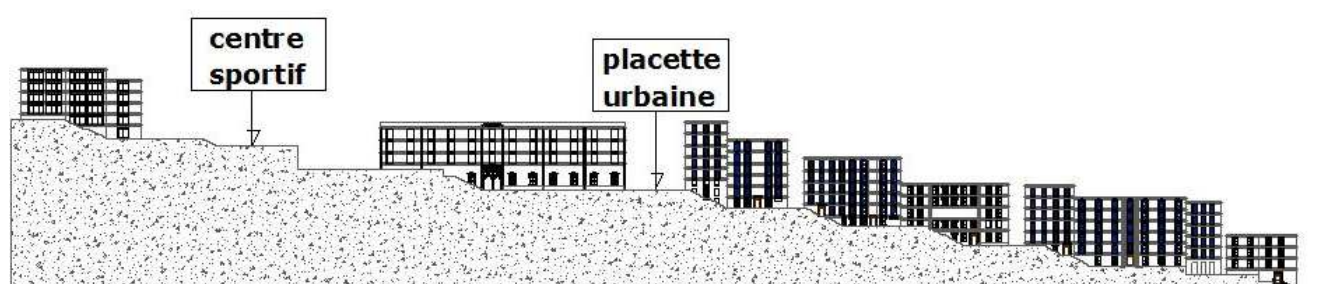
Façade urbaine du Boulevard OuridaMeddad
